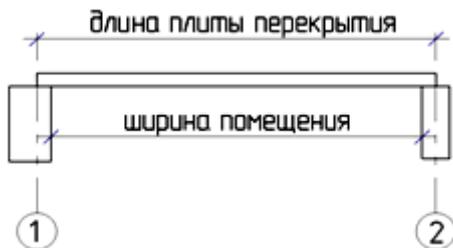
Уменьшение площади помещения за счет величины опирания элементов перекрытия
